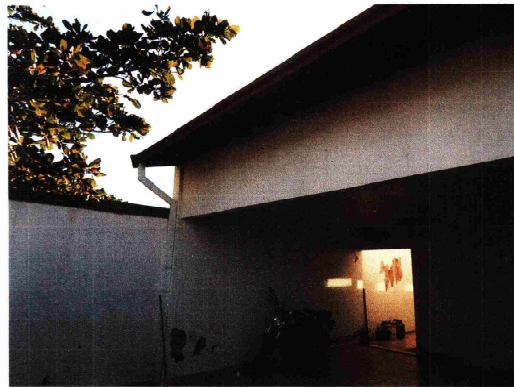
VISTA INTERNA CORREDOR LATERAL DE ACESSO AOS FUNDOS
